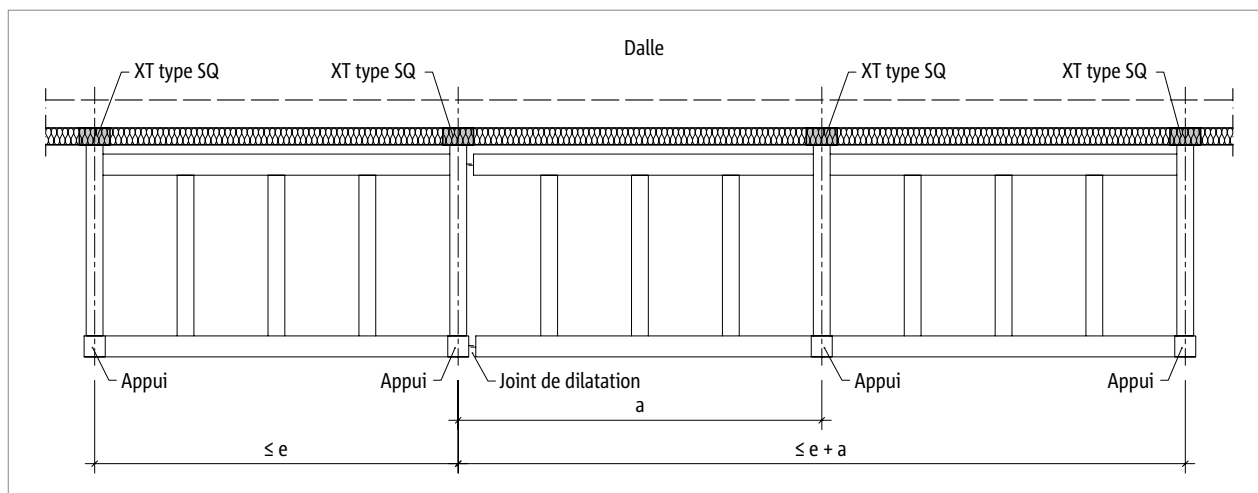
Schöck Isokorb® XT type SQ : distance maximale entre joints de dilatation e
